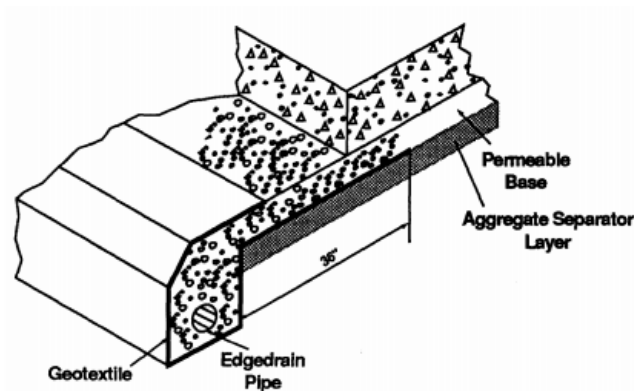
Elementos de un Sistema de drenaje de pavimento.[4]
